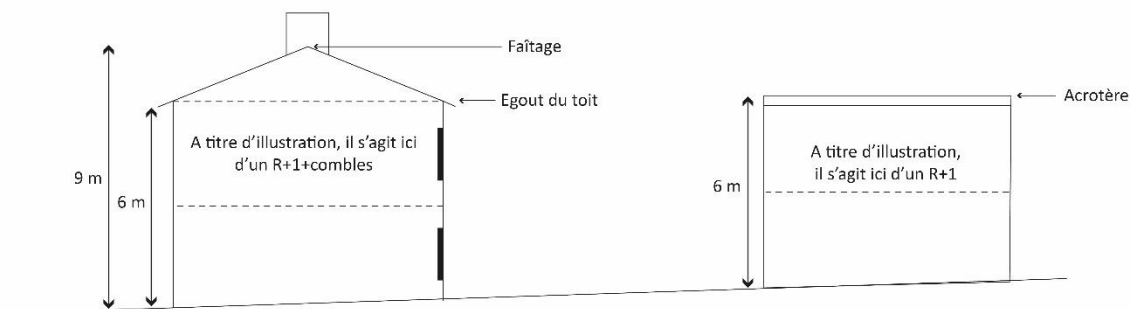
\_Hauteur maximale autorisée dans le secteur UC
